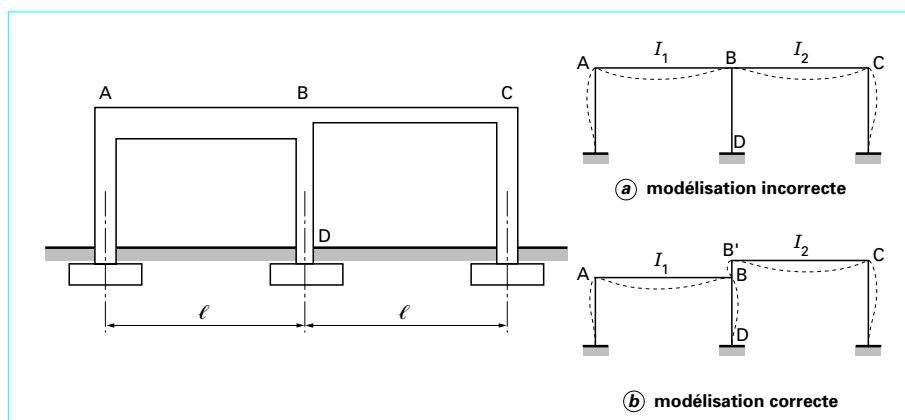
Modélisation d'un portique à deux travées d'inerties différentes
